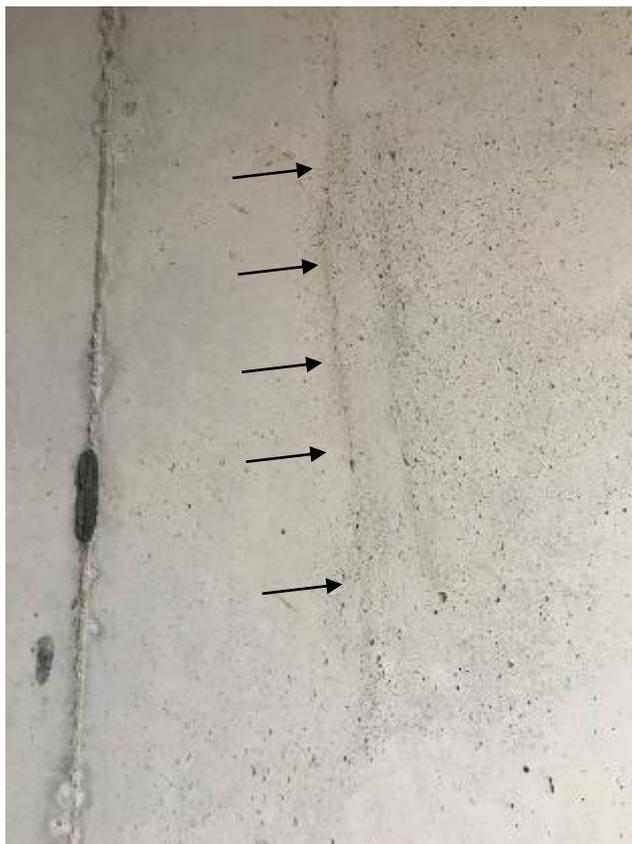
Fissura a 90° entre vão da janela e abertura para instalação de ar-condicionado
